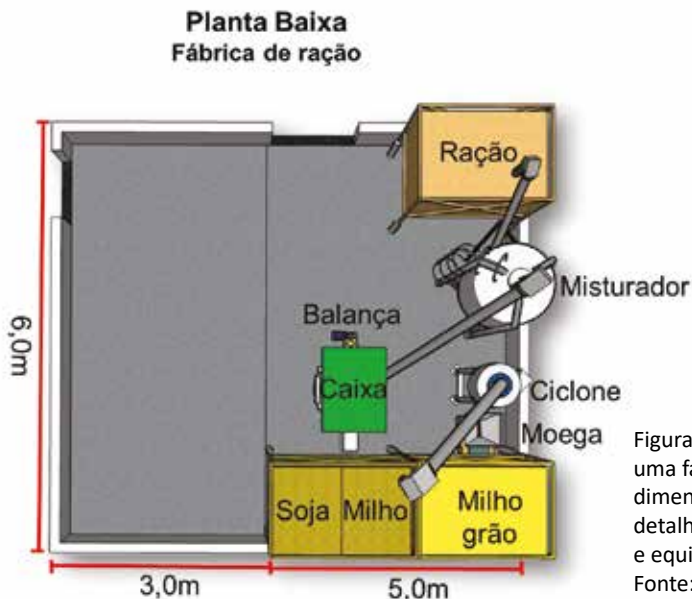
Planta baixa de uma fábrica de ração com dimensionamento básico e detalhes da distribuição de silos e equipamentos
